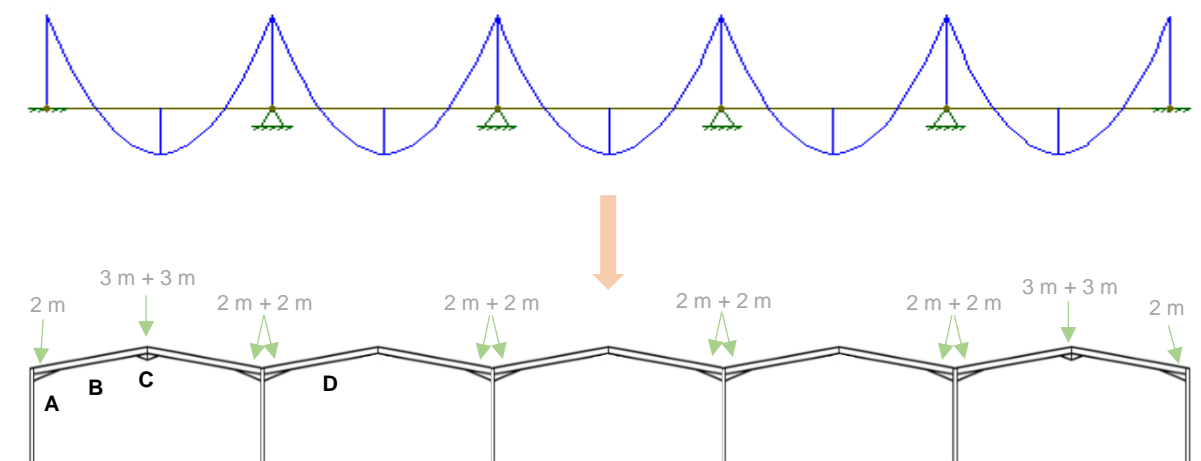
Forma do diagrama de momentos nas vigas para cargas verticais (em cima) e zonamento dos reforços de cumeeira e nas ligações pilar-viga (em baixo).
